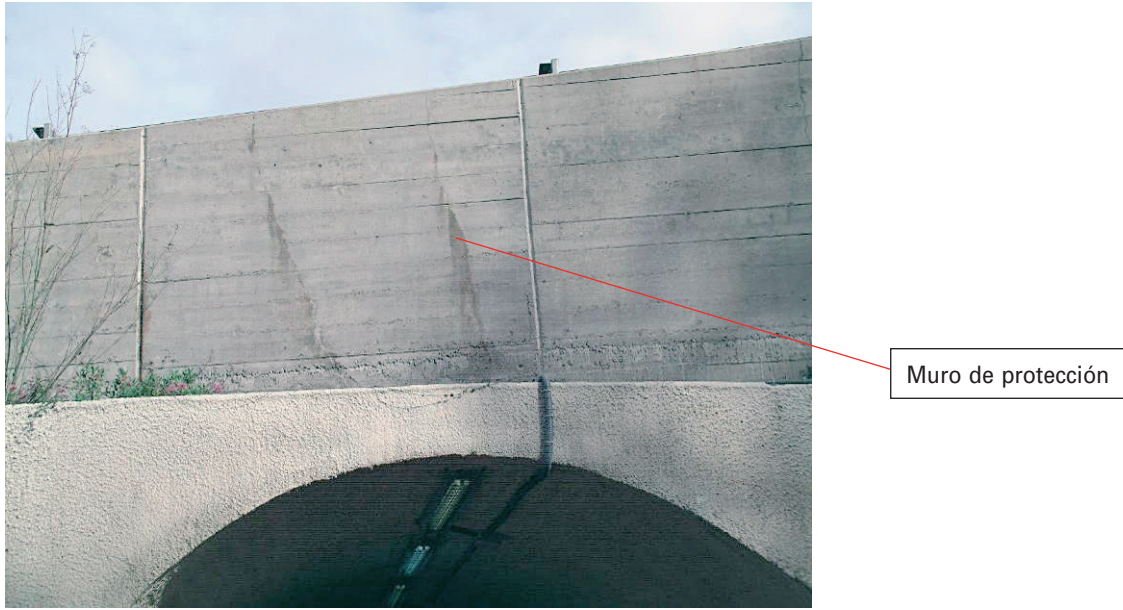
PROTECCIÓN DEL TERRAPLÉN MEDIANTE MURO.
